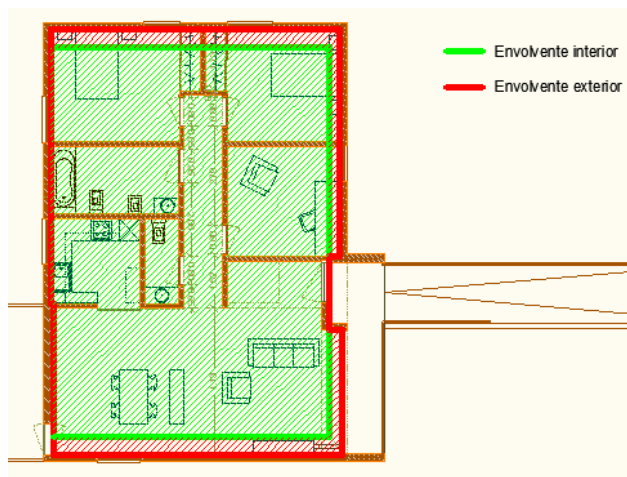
Traçado da envolvente interior e exterior em planta ao nível do pavimento
